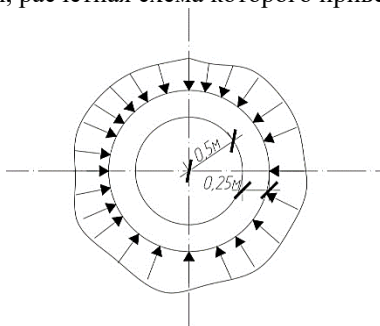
Расчетная схема определения устойчивости бетонной смеси оболочки свай от активного давления неустойчивого грунта
